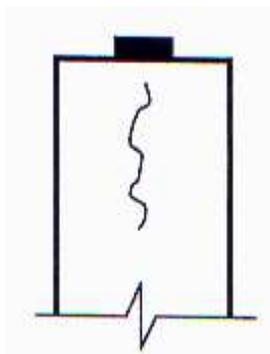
Possíveis configurações de fissuras em pontes de concreto
